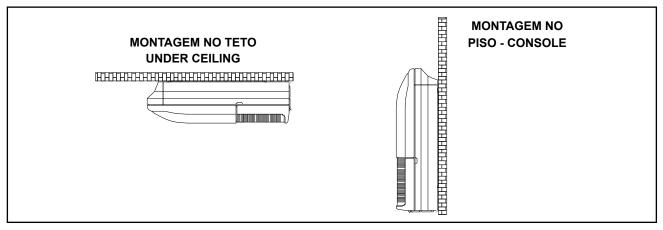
Montagem do piso (console) ou teto (under ceiling)
